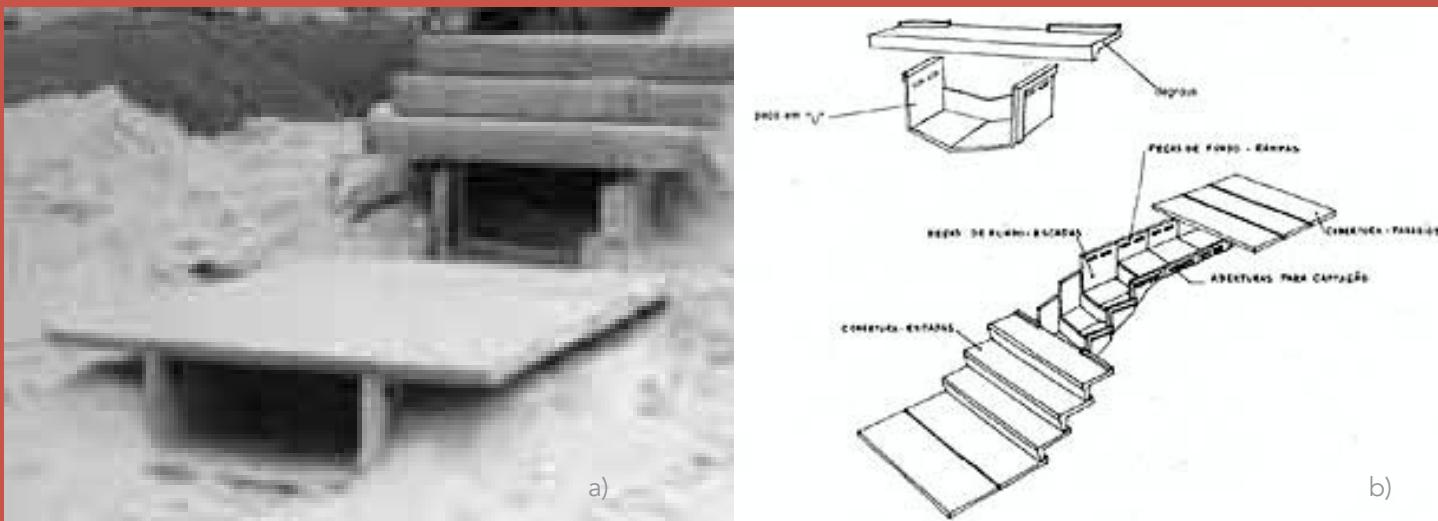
Escada drenante. a)projeto executado; b)sistema construtivo
